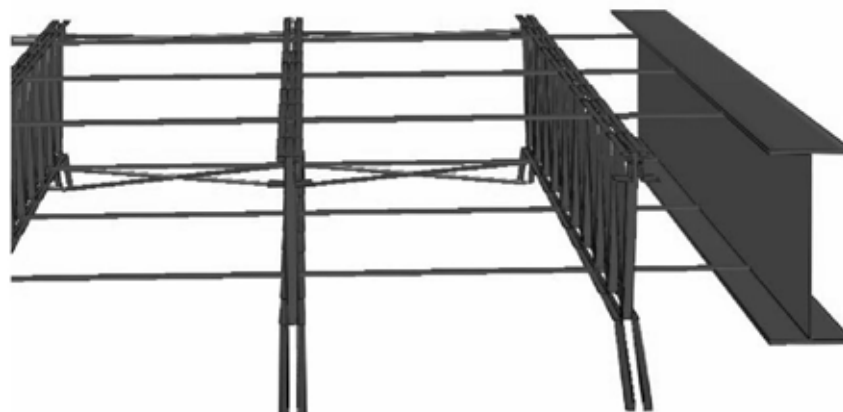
Isométrica Esquemática do Travamento Horizontal em Viga Metálica
